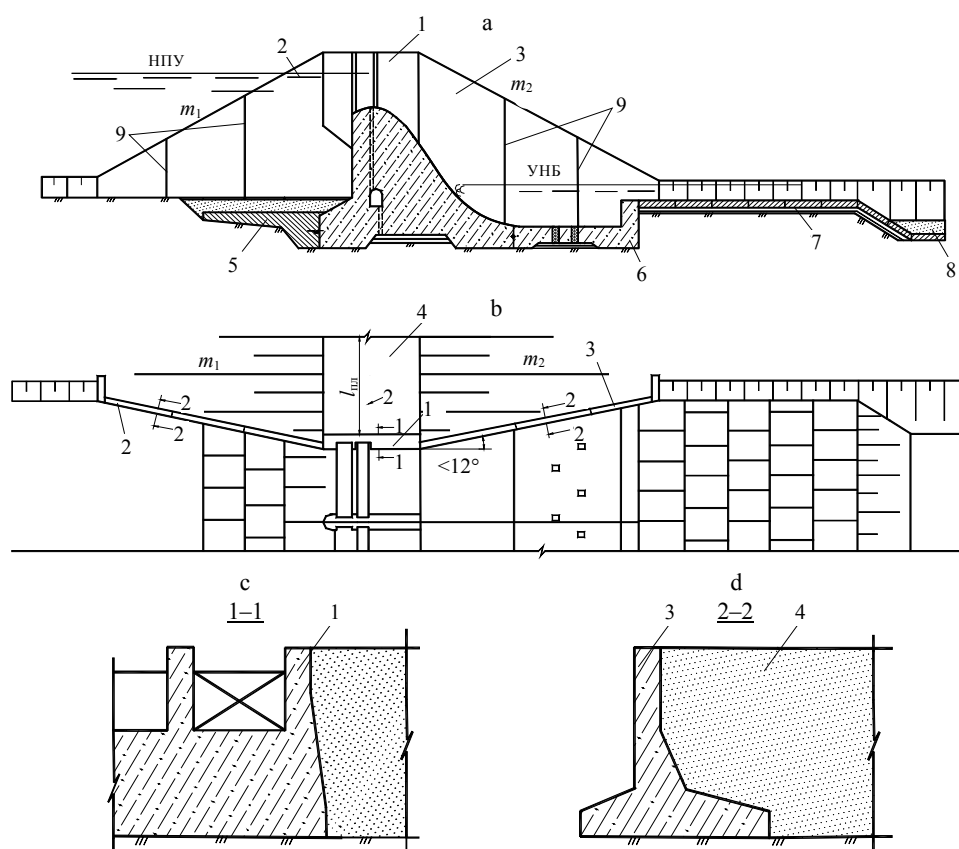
Конструкция берегового устоя: а, с, d – поперечный разрез по водосливной плотине, по вертикальной продольной стенке и по сопрягающим открькам; б – план; 1 – вертикальная продольная стенка; 2, 3 – верховой и низовой сопрягающие открьки; 4 – земляная плотина; 5 – понур; 6 – водобой; 7 – рисберма; 8 – ковш; 9 – конструктивные швы
